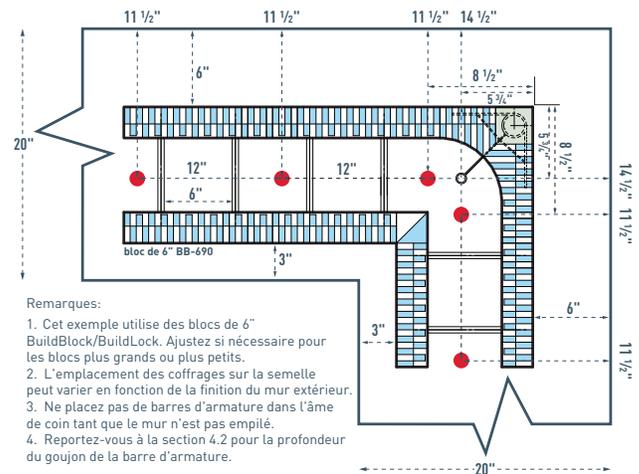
Schéma de placement des goujons de semelle pour le support à maçonnerie.
